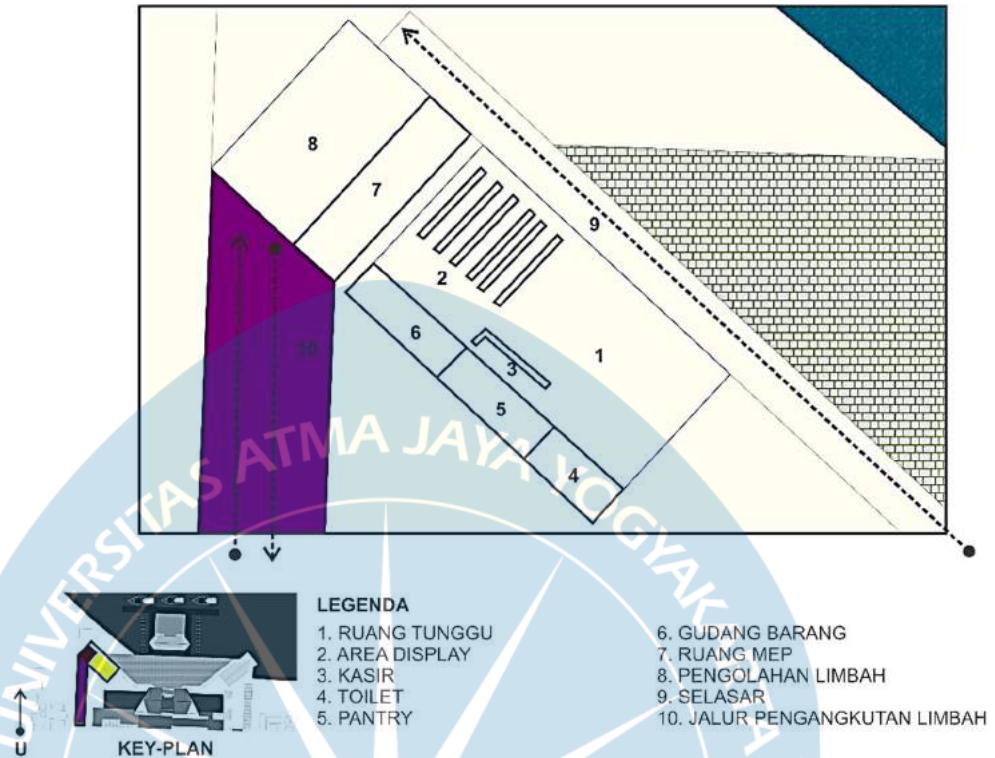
Tata Ruang Bangunan Kuliner indoor dan Pengelola lantai 2
